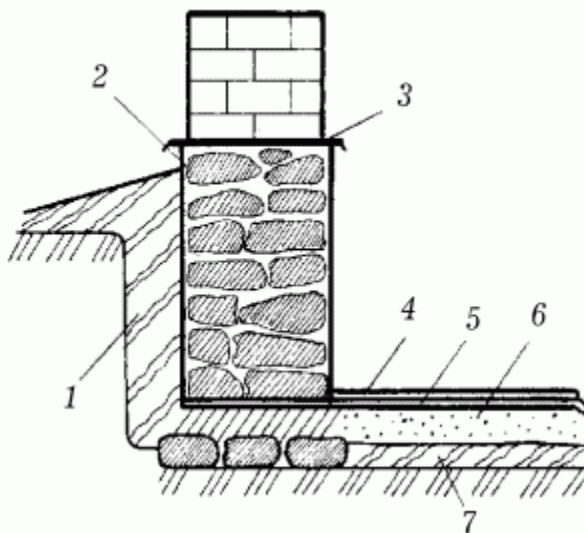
Гидроизоляция фундаментов традиционными рулонными материалами: 1 – глина; 2 – слой цементного раствора, снаружи покрытый битумом; 3 – гидроизоляция; 4 – цементный пол; 5 – гидроизоляция; 6 – слой керамзита; 7 – глина.
